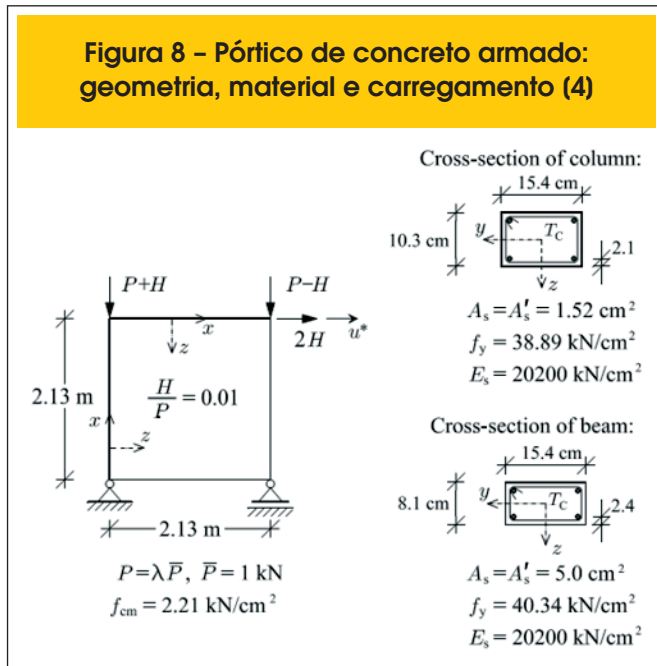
Pórtico de concreto armado: geometria, material e carregamento (4)
